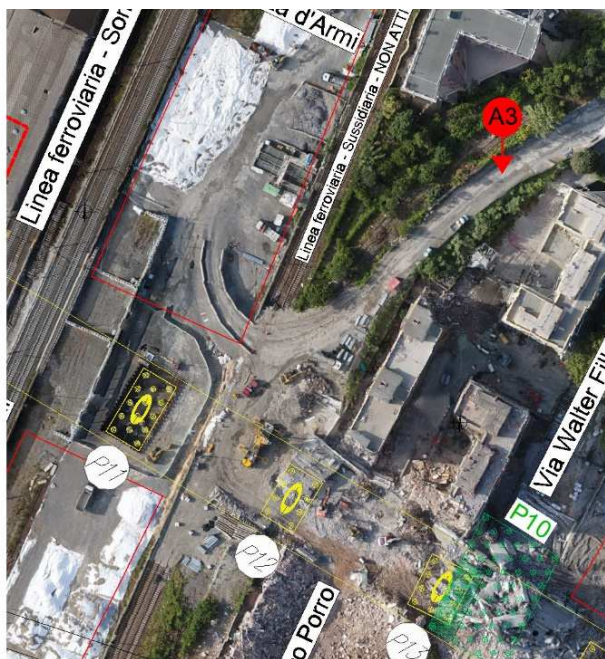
Postazione levante a Nord (44.425934 N, 8.890475 E) – PPN2 - A3
